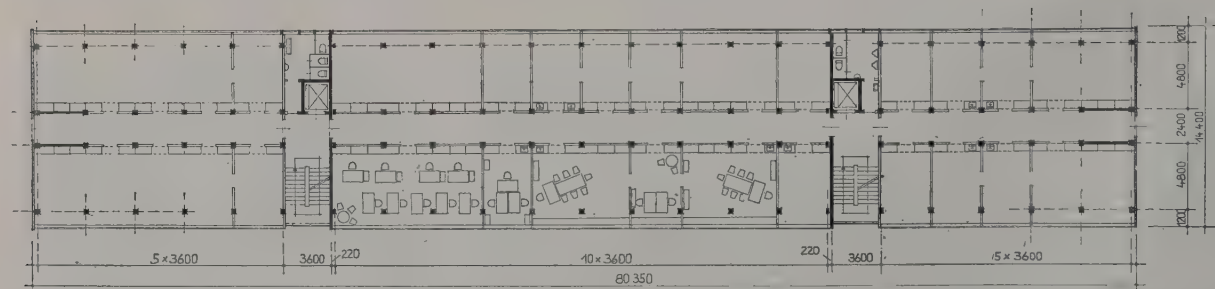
Grundriß eines Verwaltungsgebäudes 1:500
